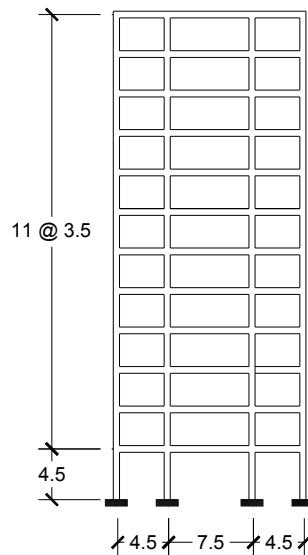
Geometría del marco plano irregular en planta de doce niveles (dimensiones en metros)
